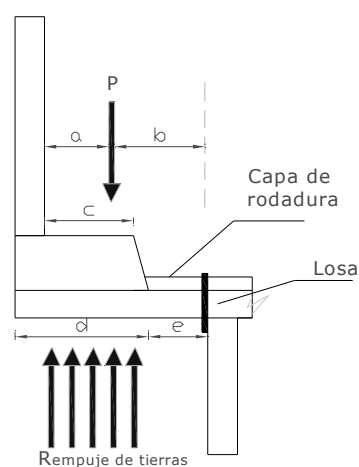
22 Distribución de carga en la sección transversal en una losa de acero
